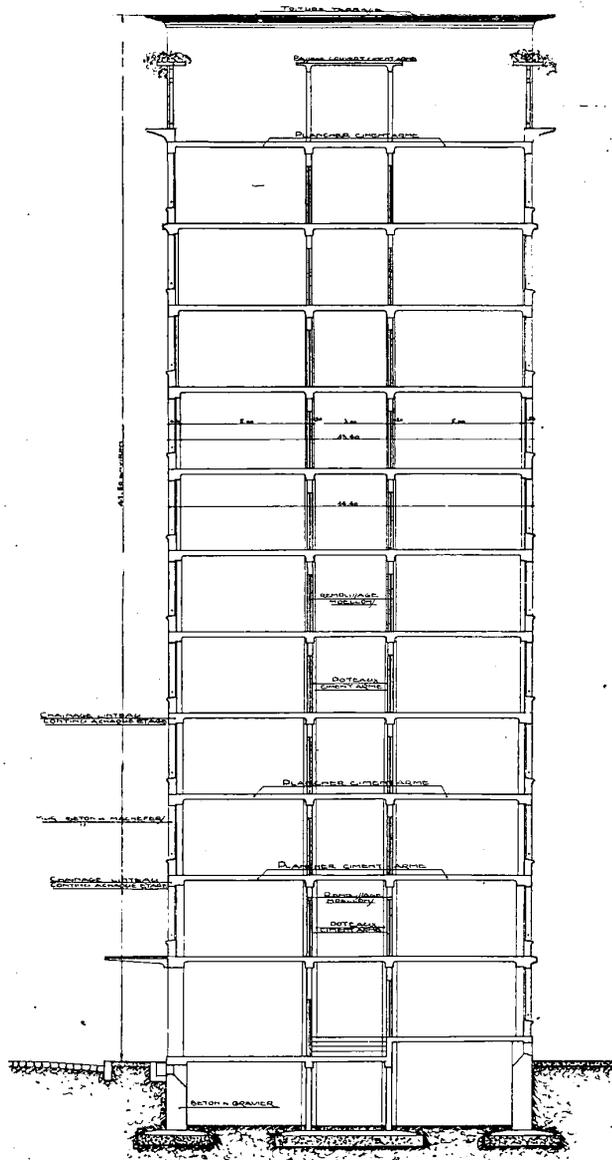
Coupe transversale d'une aile de l'immeuble ; ossature en béton de ciment armé.
